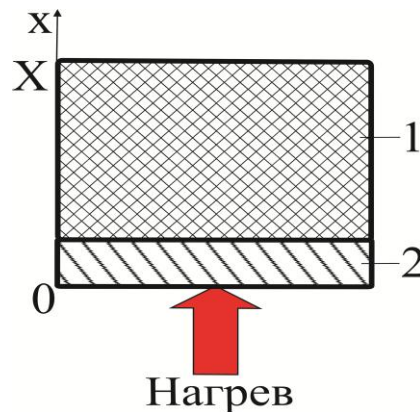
Схема исследуемого монолитного перекрытия: 1 – слой перекрытия; 2 – слой огнезащитного покрытия.
